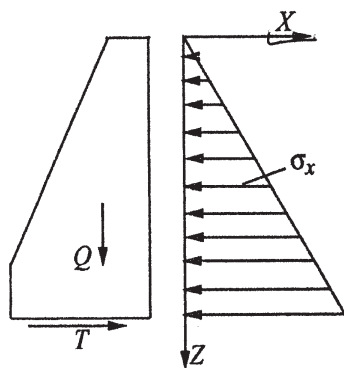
Эпюра давления грунта на гладкую вертикальную подпорную стену γ_x
